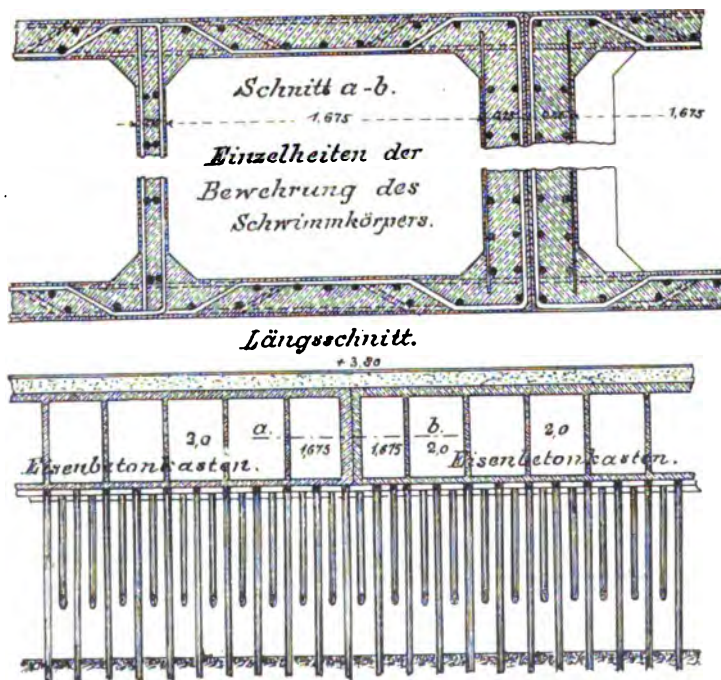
und 150. Umbau der Kaimauer am Eisenbahnhafen in Rotterdam.
